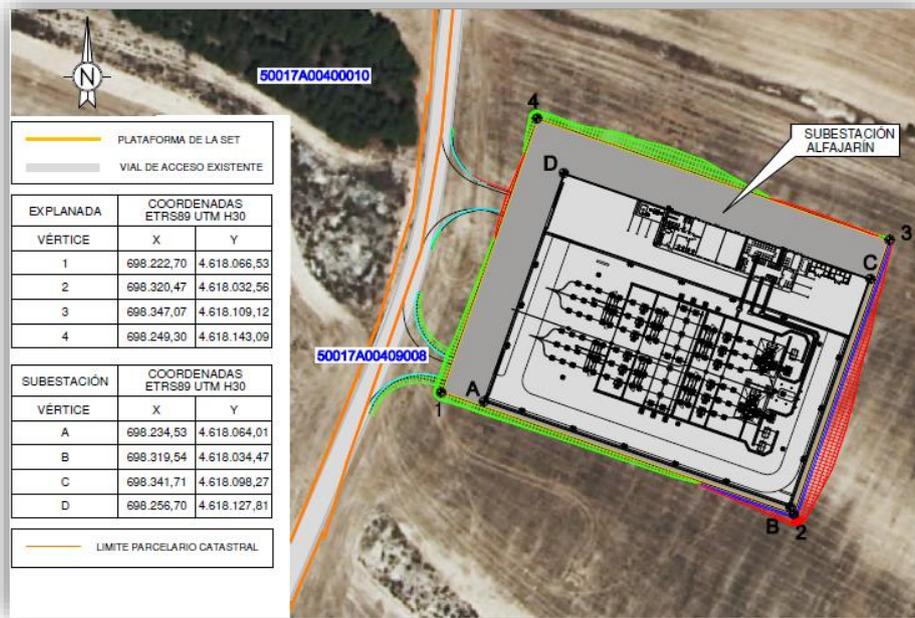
Plano-Diagrama de planta de la SET Alfajarín.
